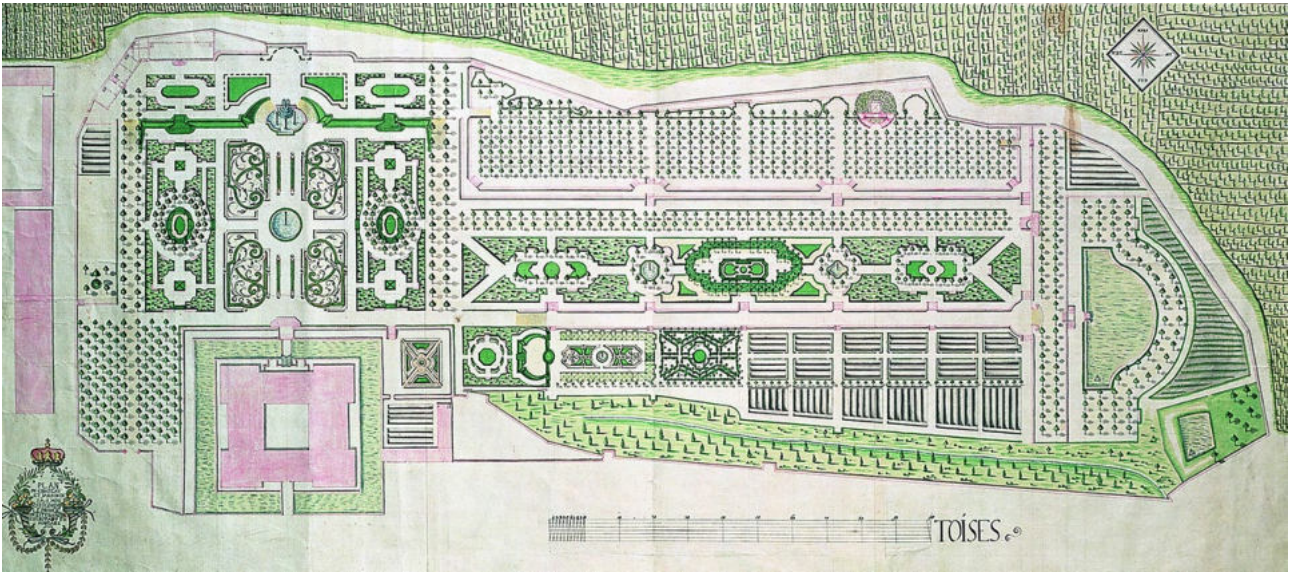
Planzeichnung des Schlossgartens in Eisenstadt, Federzeichnung, 1760
